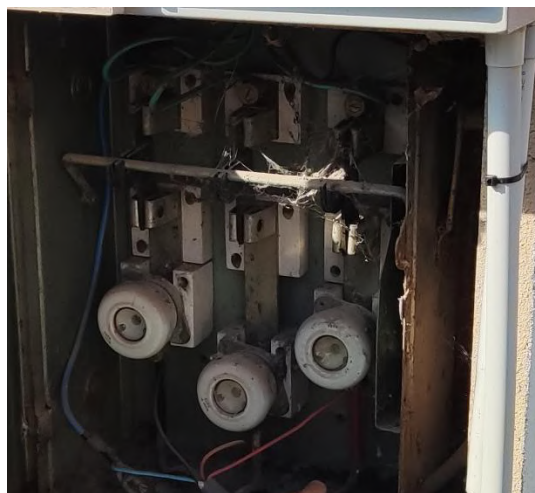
Tablero Pilar calle Bernal – CET N°6
